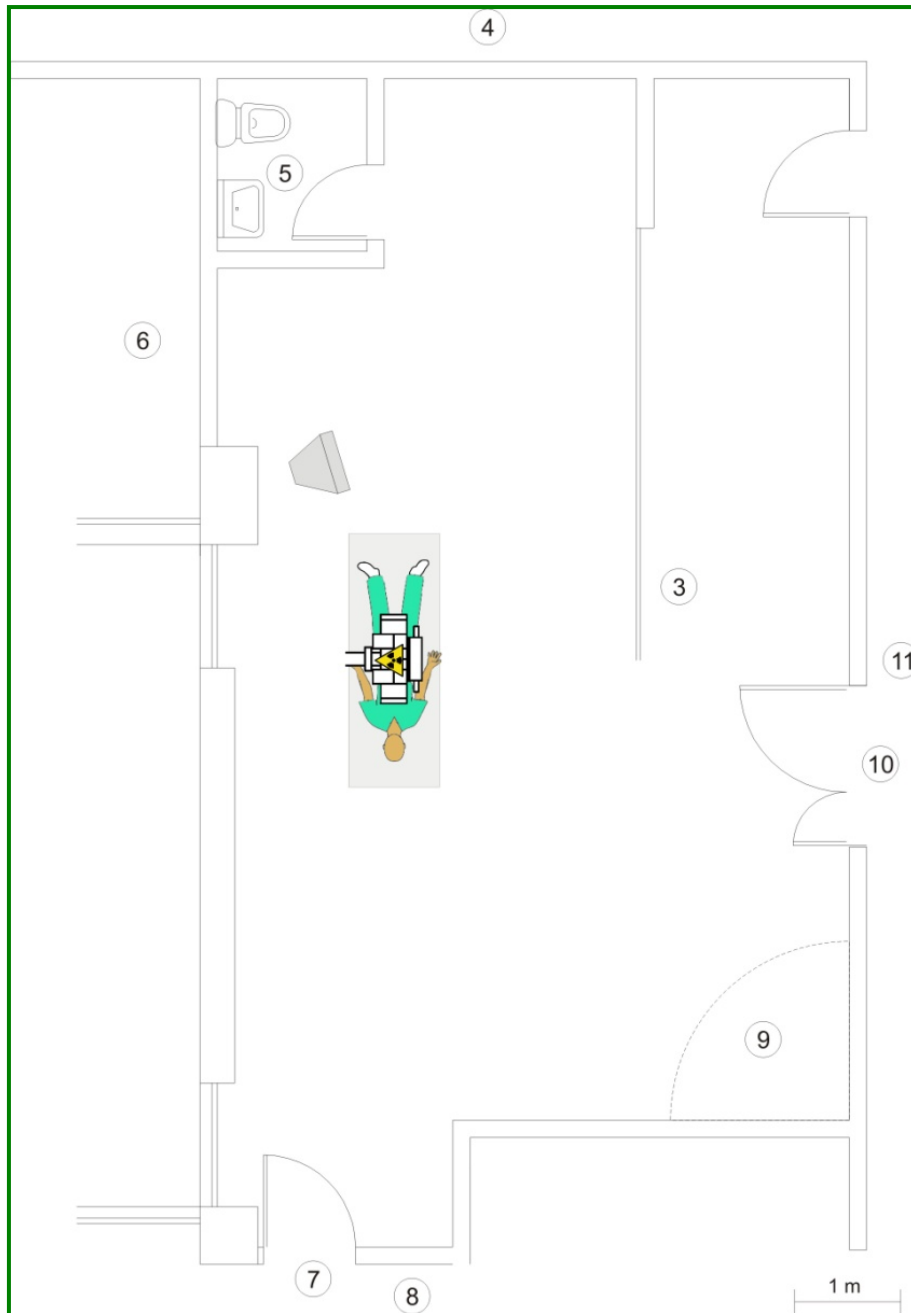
Planta arquitectónica da sala de Fluroscopia (Sala 3).
